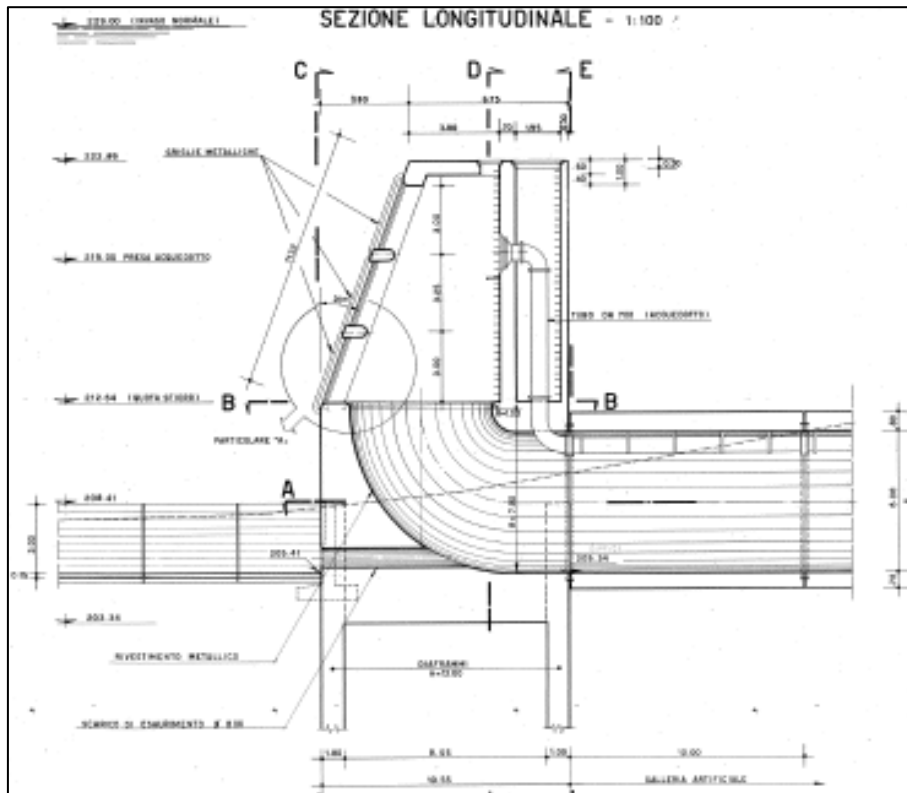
Opera di imbocco scarico di fondo – Sezione longitudinale
